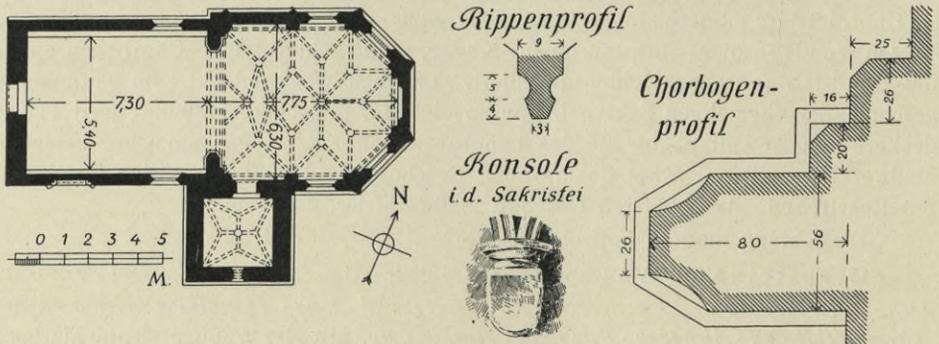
Salzdorf. Kirche. Grundriß und Details.
